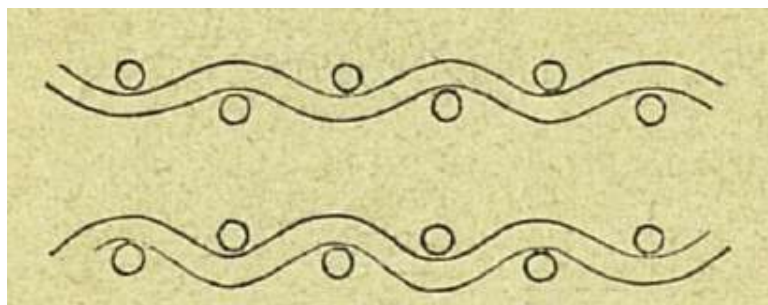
Sistema de armado de Bordenave, en el que las armaduras se entrecruzan a modo de un tejido. Del libro de Luengo y Carrascal, *Construcciones de Cemento Armado de 1902*.
